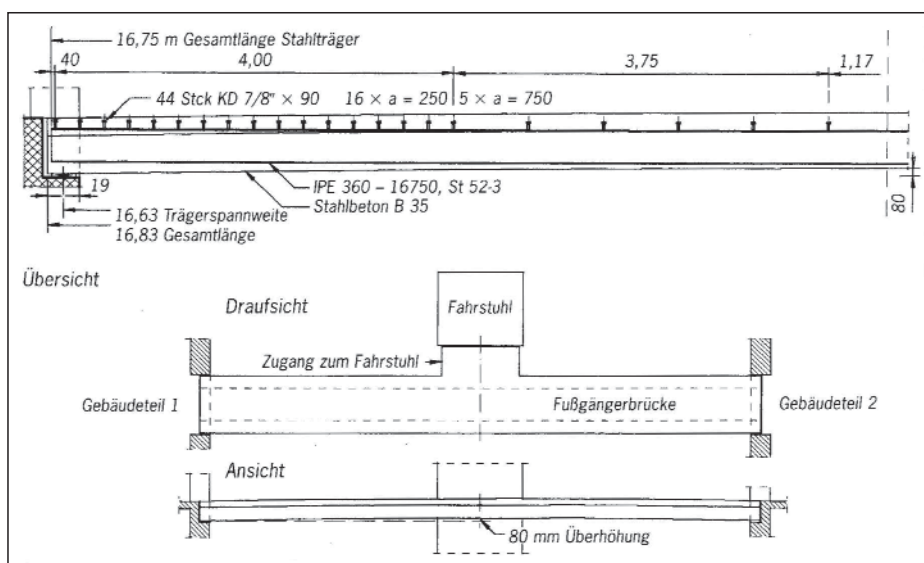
Längsschnitt und Draufsicht einer Fußgängerbrücke
